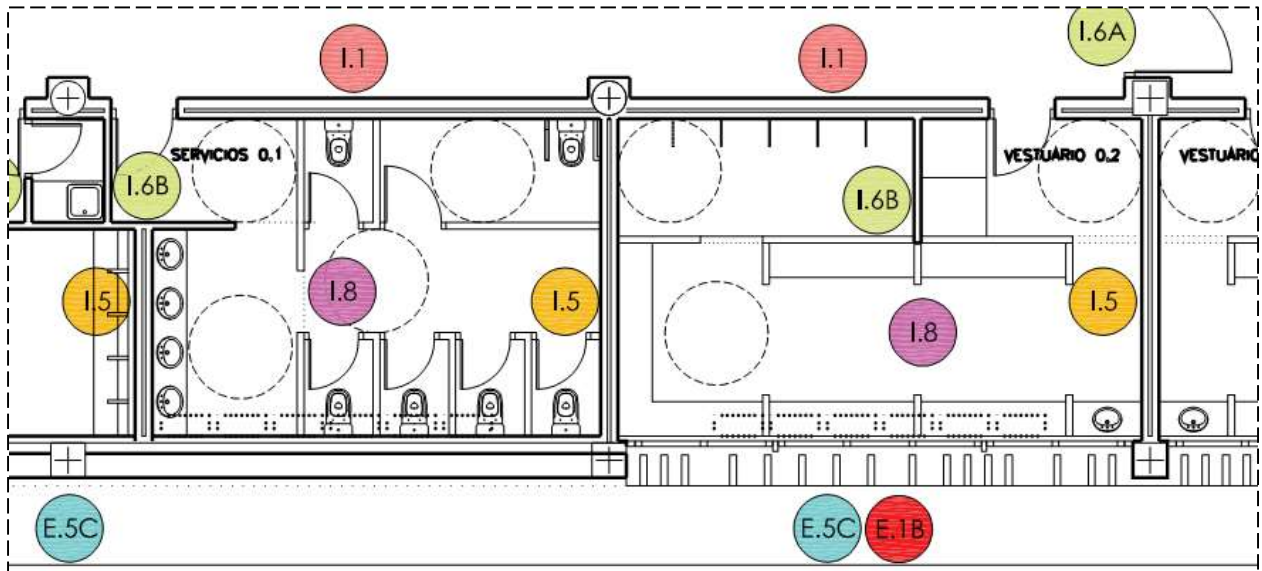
Detalle del plano RP-4 (m1), de particiones interiores de planta baja.
